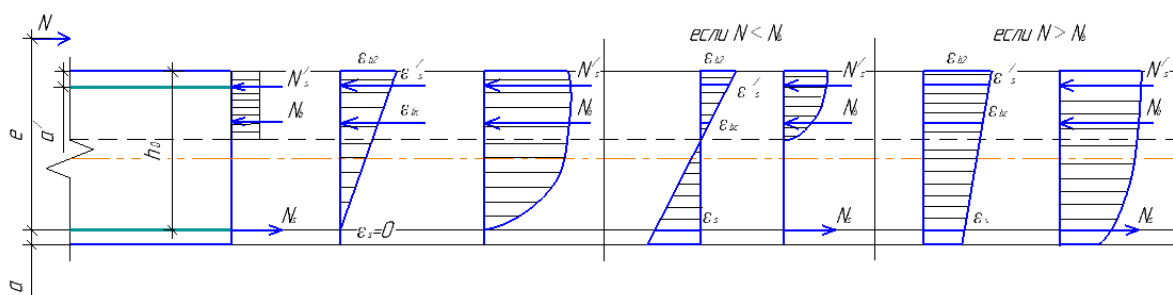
Расчетная схема внецентренно сжатого железобетонного элемента
